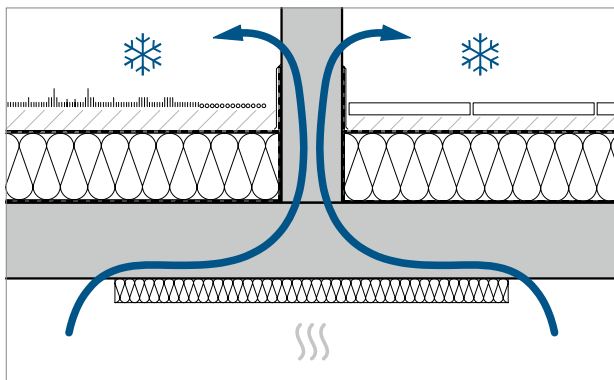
Pos ①: Warmtestroom garagemuur met Schöck Sconnex® type W
